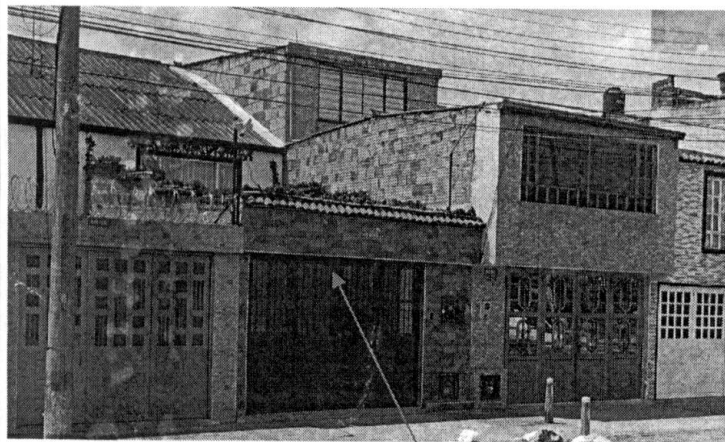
FACHADA QUERELLADO 2 KR 50 40 60 S
